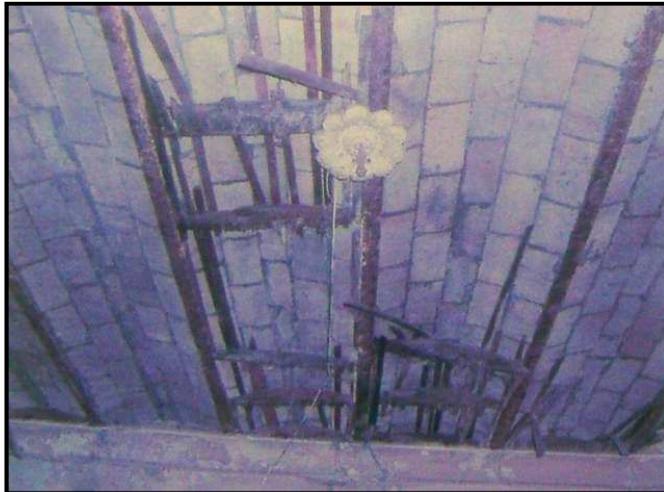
116 : Maison Ingliz Bey : Plancher du premier étage, en voutains, supportés par des poutrelles métalliques de type IPN avec un remplissage en briques pleines. Source : le propriétaire de la maison.
